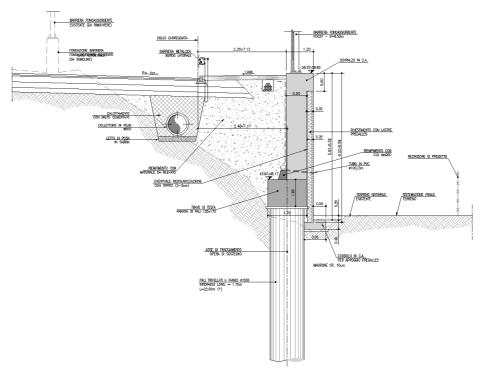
Sezione tipo opera di sostegno MS022 – Tratto 2
